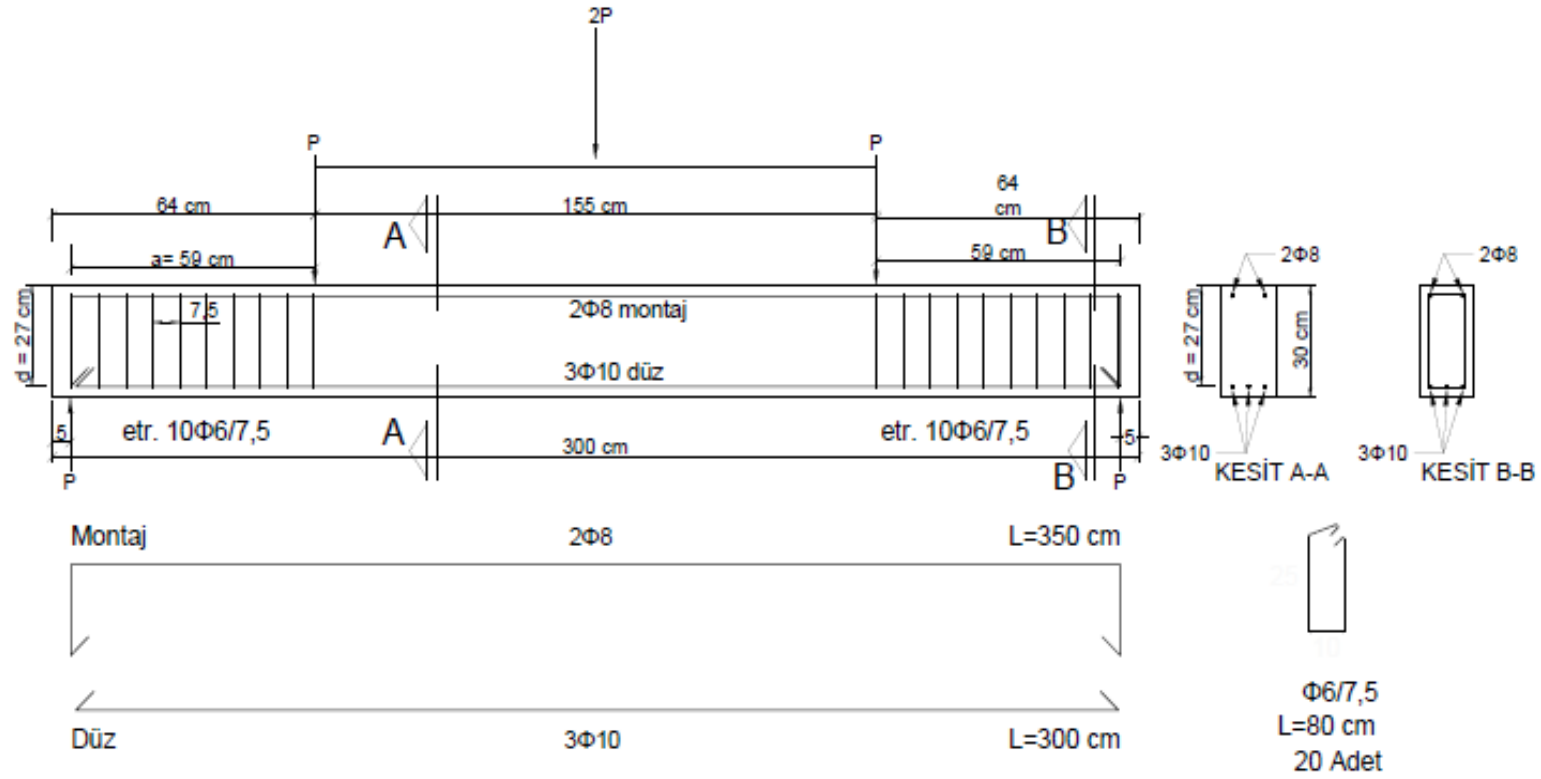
Betonarme Kiriş -1 (RCB-1) Deney Elemanı
